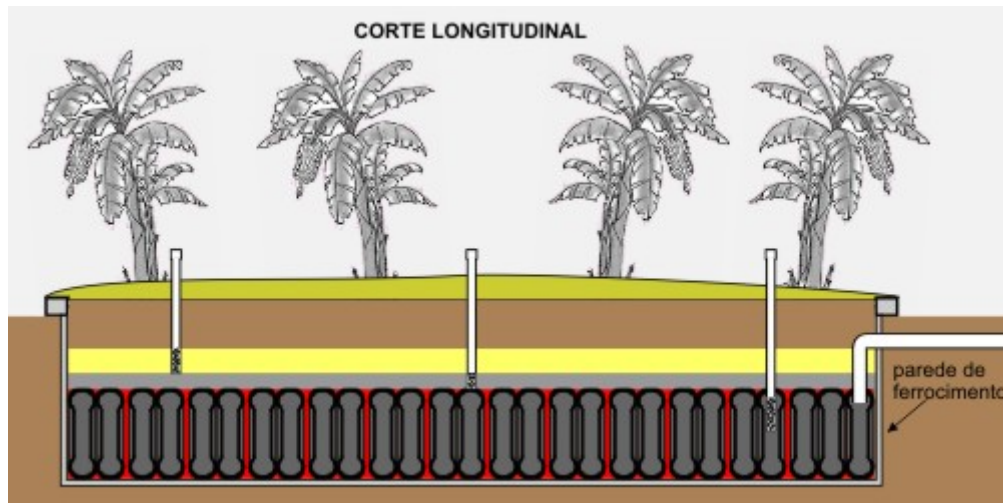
Esquema de Construção do Tanque de Evapotranspiração (Corte Longitudinal)
